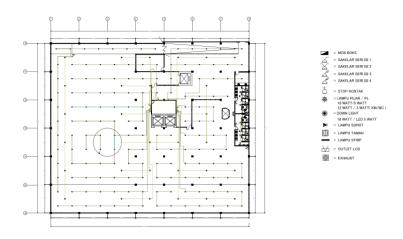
Denah Rencana Listrik, Stop Kontak Dan Saklar Lantai 1
